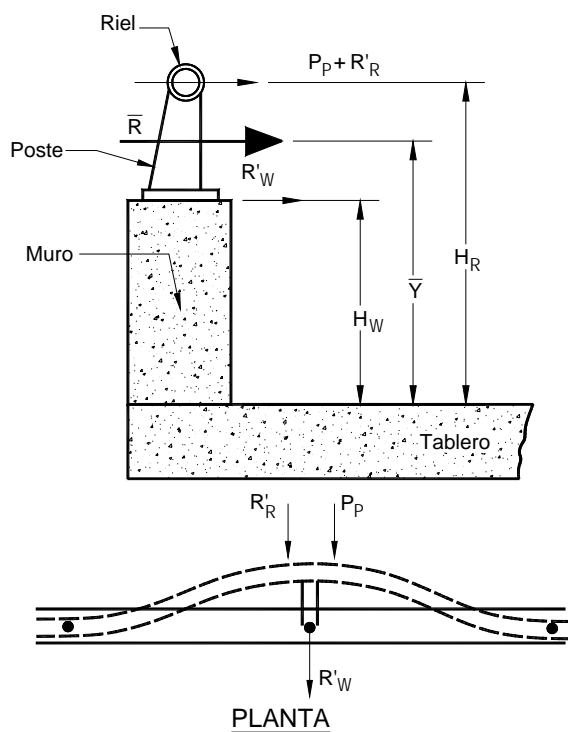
Evaluación del conjunto formado por un muro de hormigón y un riel metálico – Impacto en un poste
